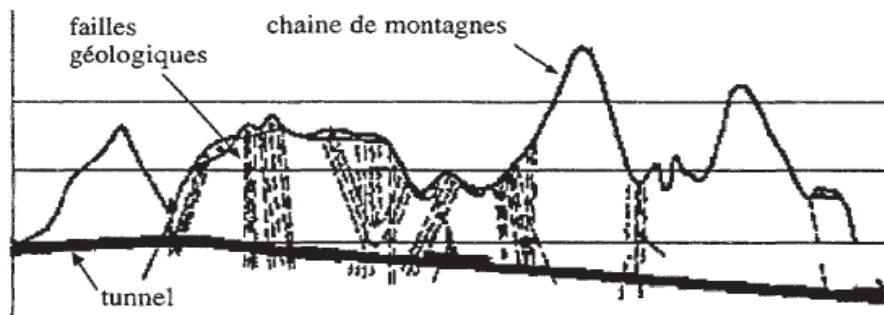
Coupe longitudinale du tracé d'un tunnel
